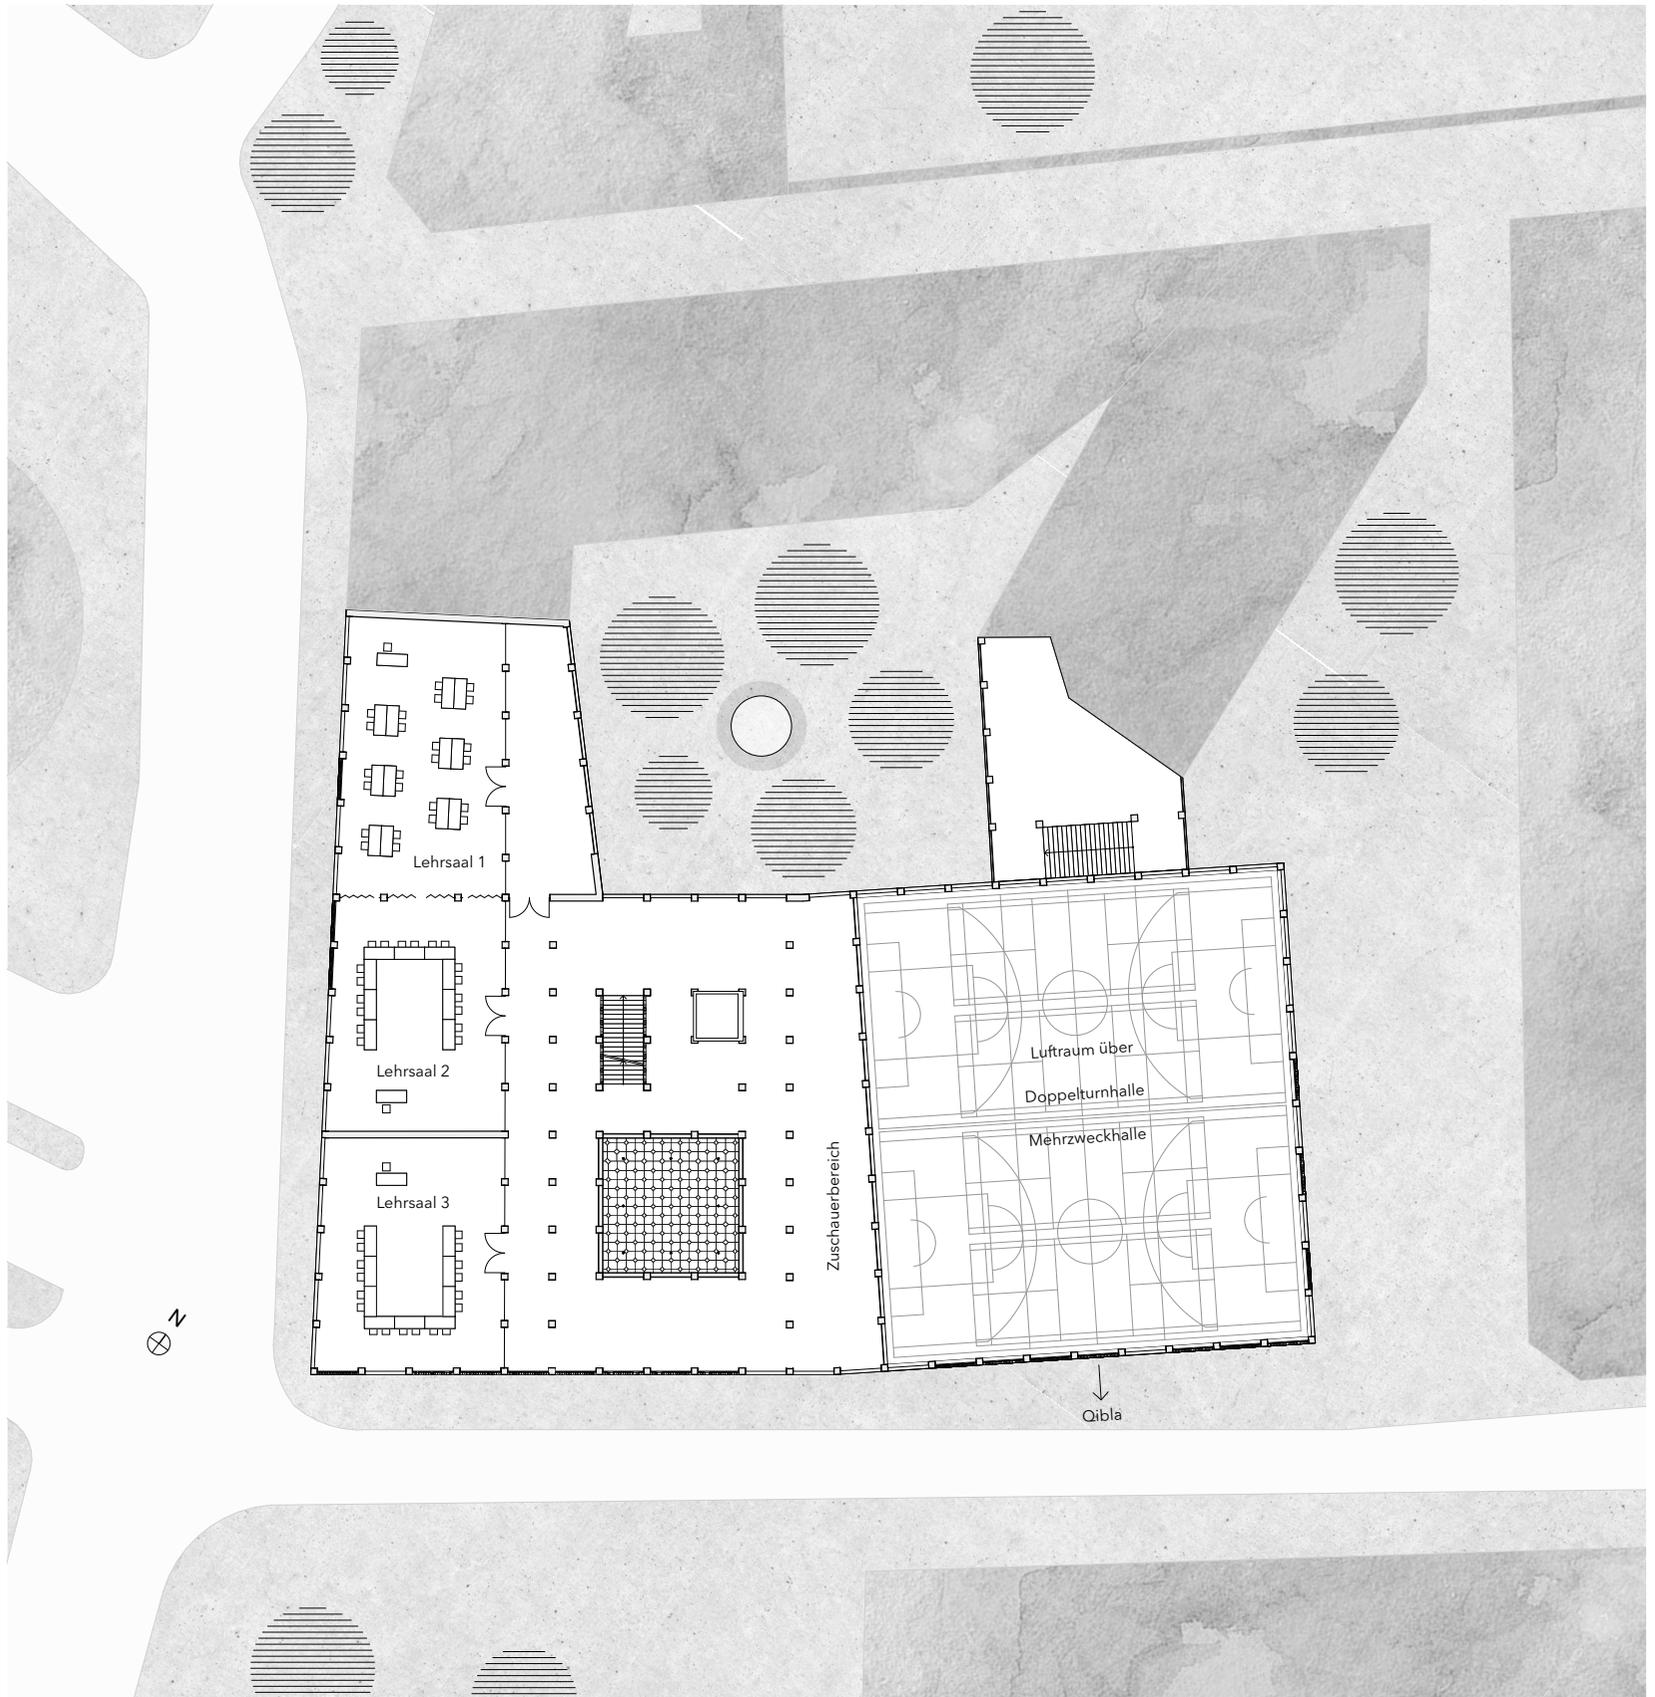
Grundriss Ebene 3 | 1:500
